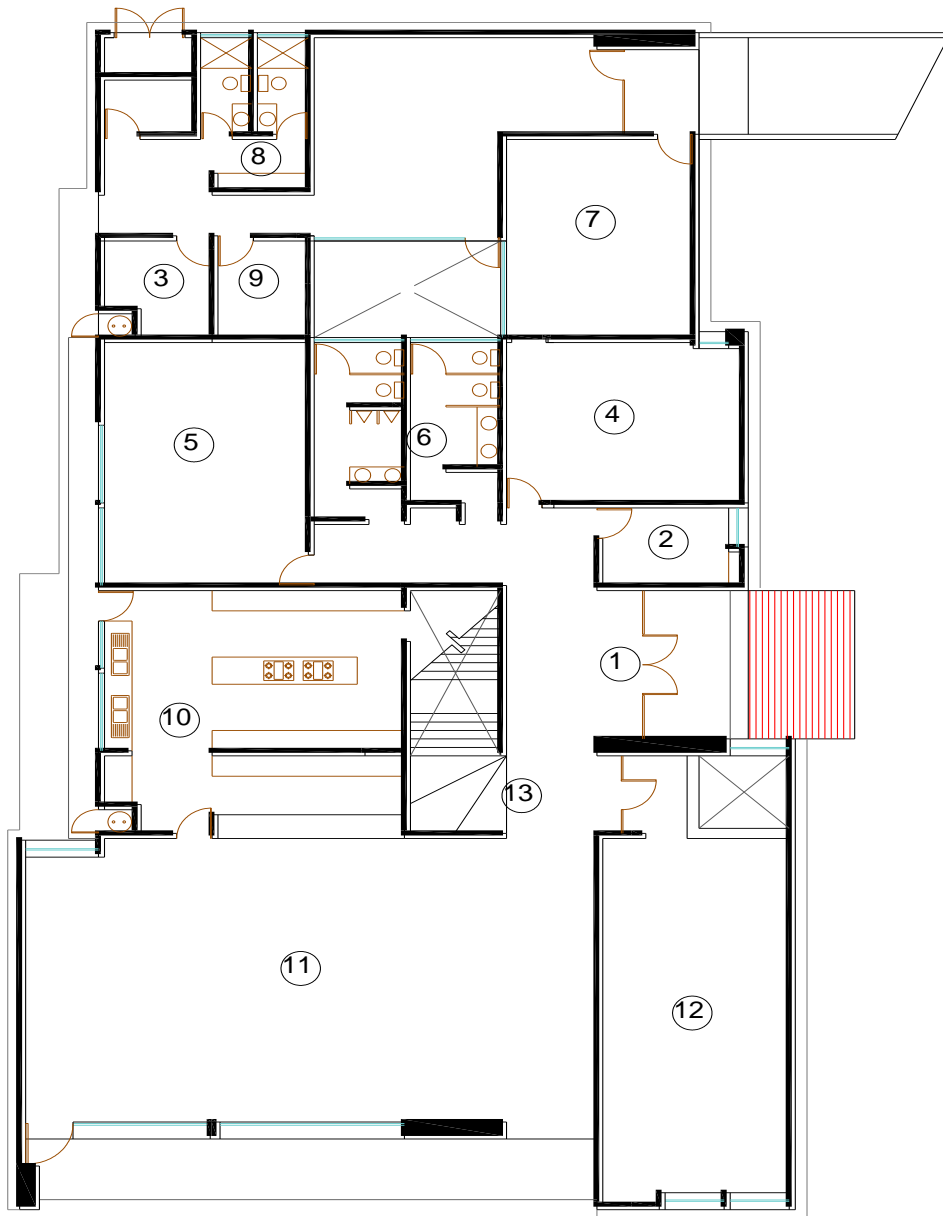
Planta baja del edificio de usos Múltiples.
